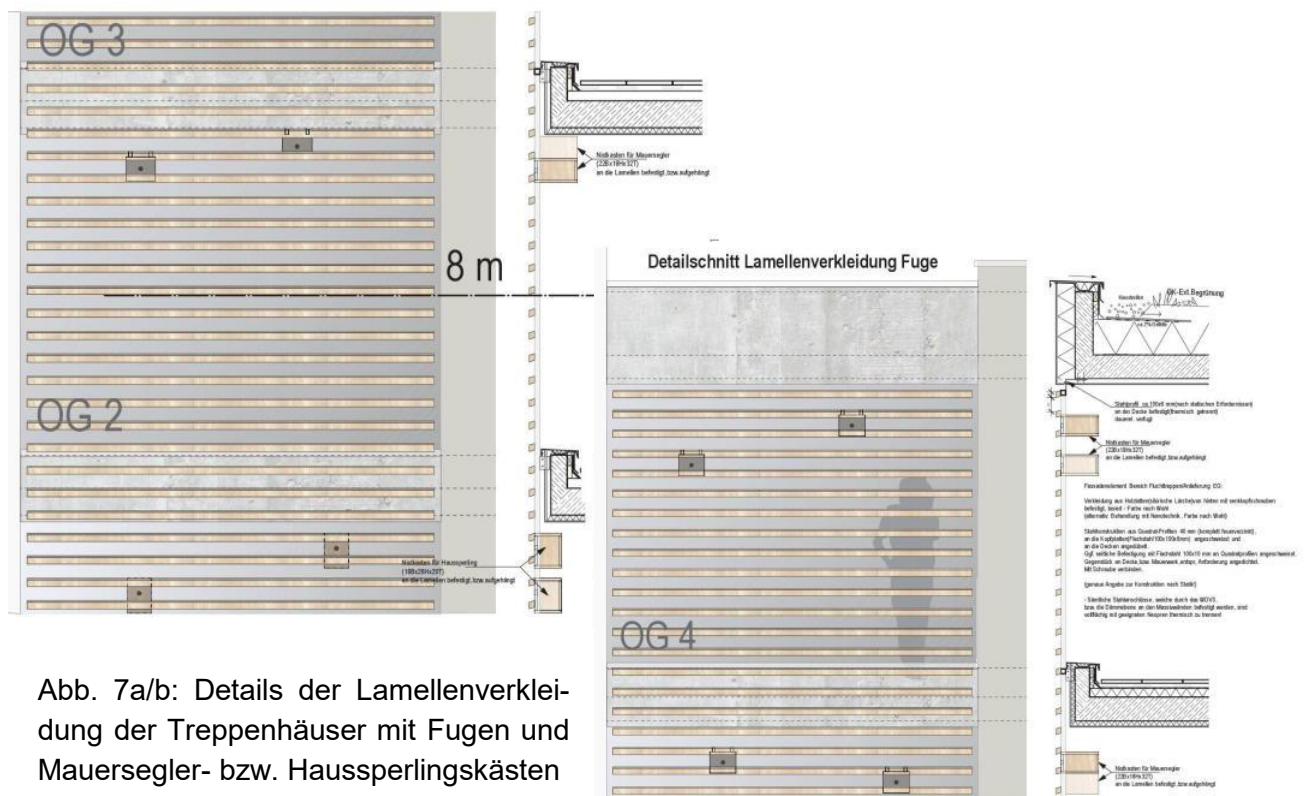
/b: Details der Lamellenverkleidung der Treppenhäuser mit Fugen und Mauersegler- bzw. Haussperlingskästen
